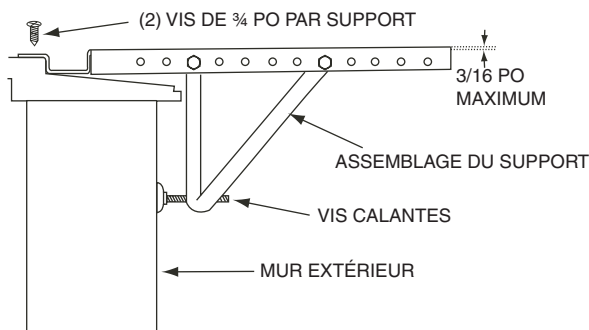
EMPLACEMENT ET INSTALLATION DU SUPPORT
